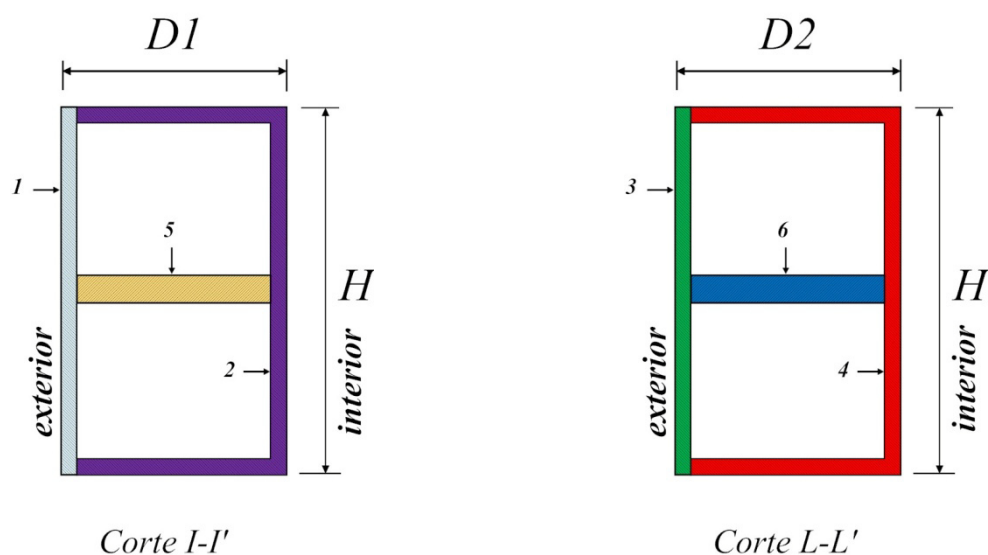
Cortes secção VIGA 1 e VIGA 2
